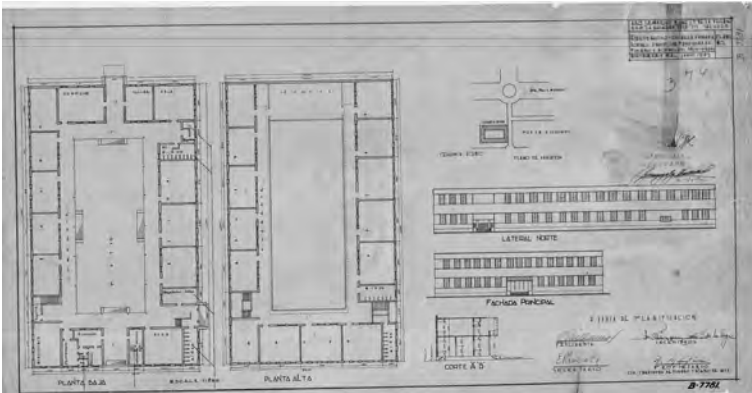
Plano B-7781 Proyecto Escuela Primaria Acero. Propiedad Compañía. Fundidora de Hierro y Acero de Monterrey. Monterrey, N.L., junio 1943.
